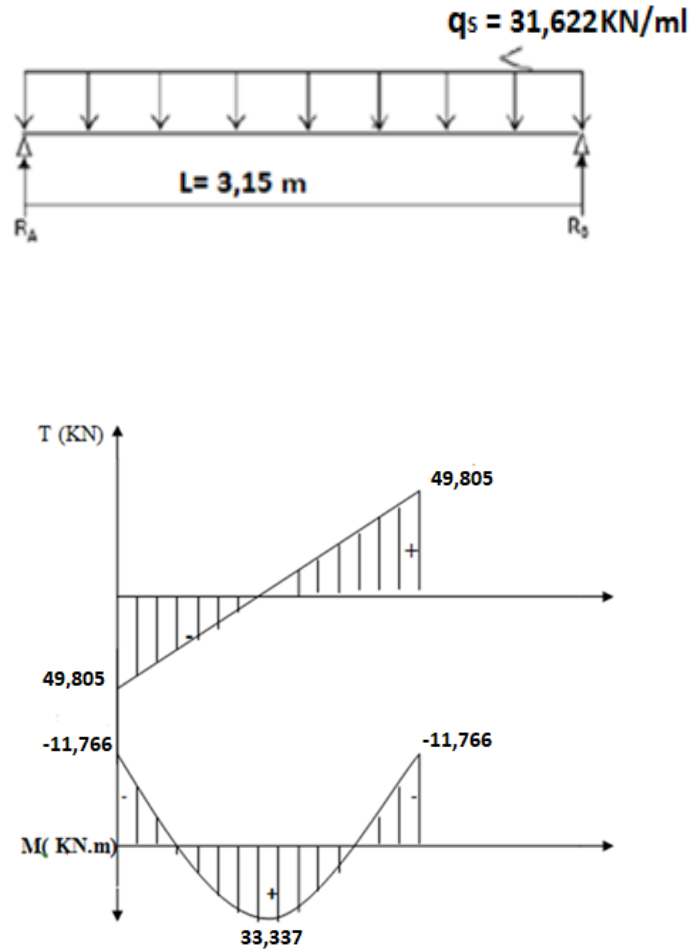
Schéma statique de la poutre palière a l'ELS.
